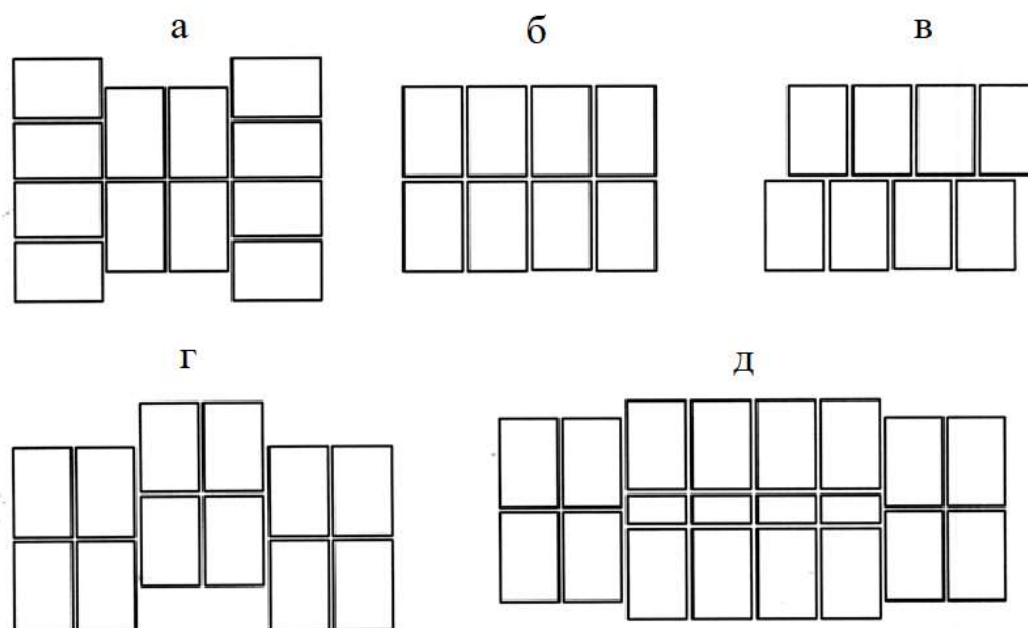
Основні конструктивні схеми будівель з об'ємних блоків (ОБ): а – з повернутими ОБ; б – з рядовим розташуванням ОБ; в – зі зсуванням ОБ уздовж поздовжньої осі; г, д – зі зсуванням ОБ уздовж поперечної осі
